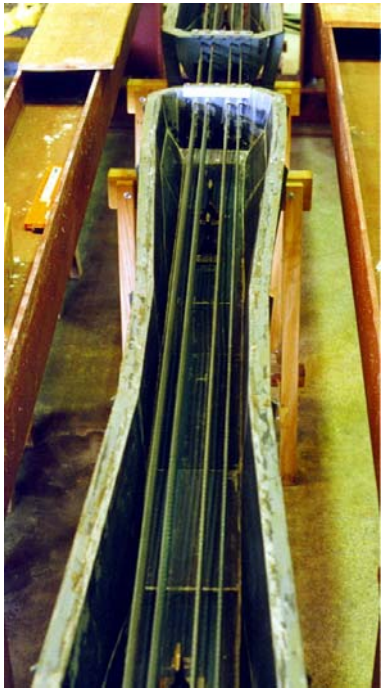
Aplicação de protensão numa viga biapoiada (LEONHARDT & MÖNNIG, 1982).
